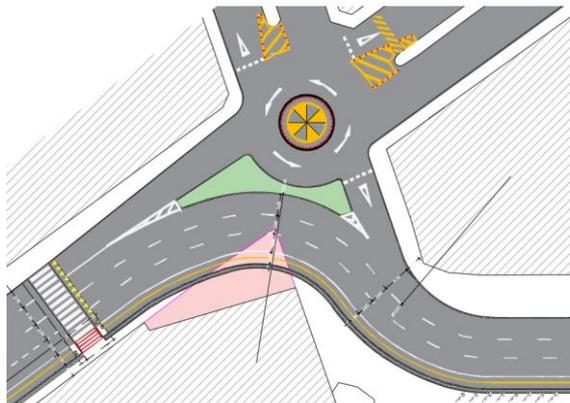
cruzamento da Av. João Câmara e Av. Comte. Petit
